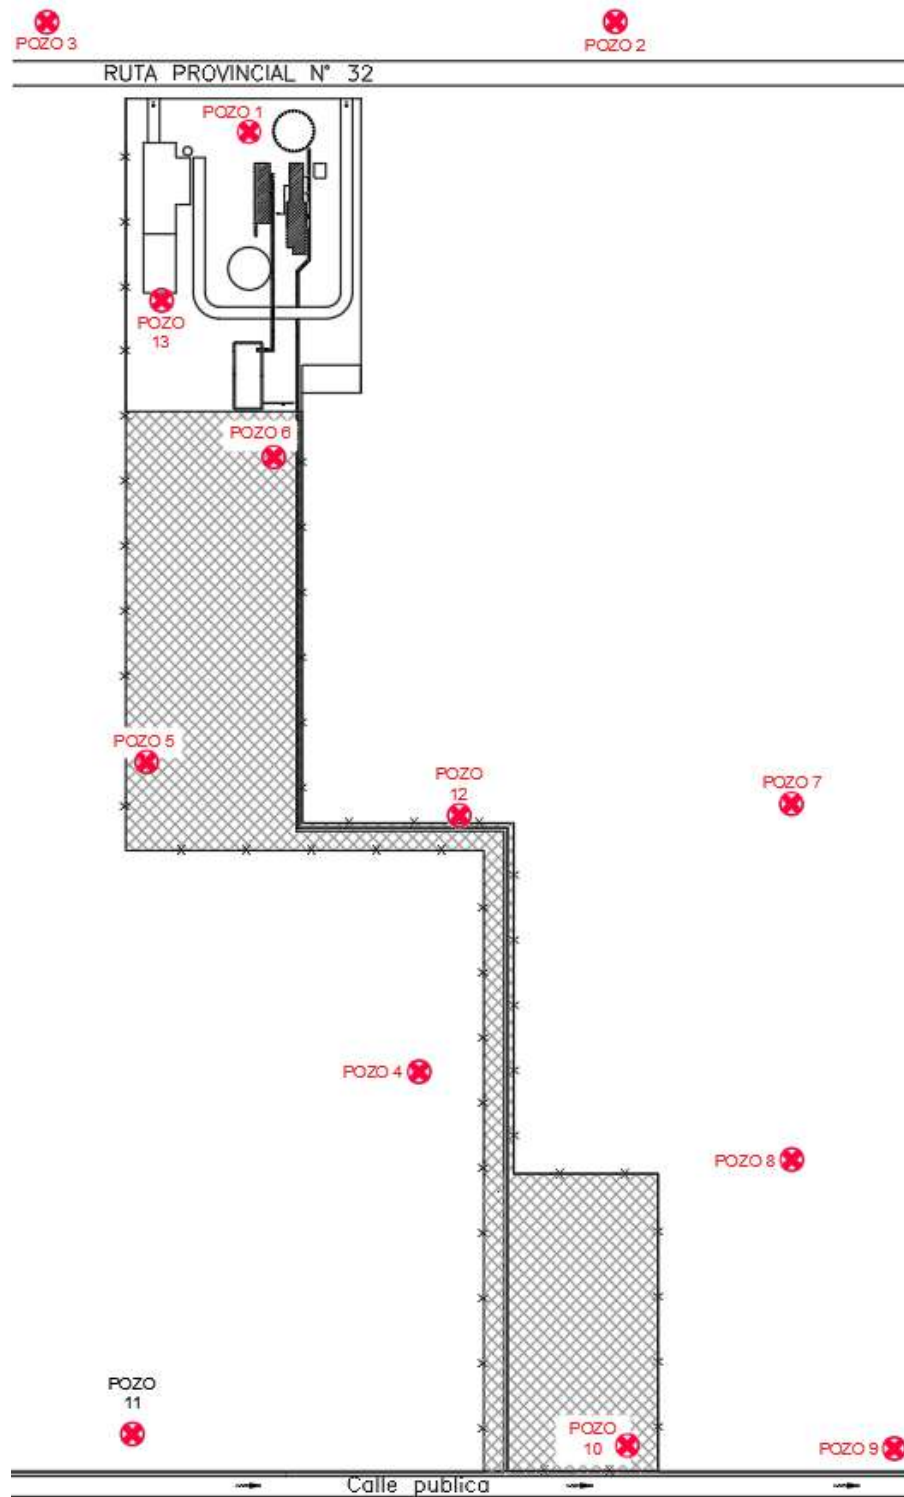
Ubicación de las perforaciones – Fuente de elaboración propia
